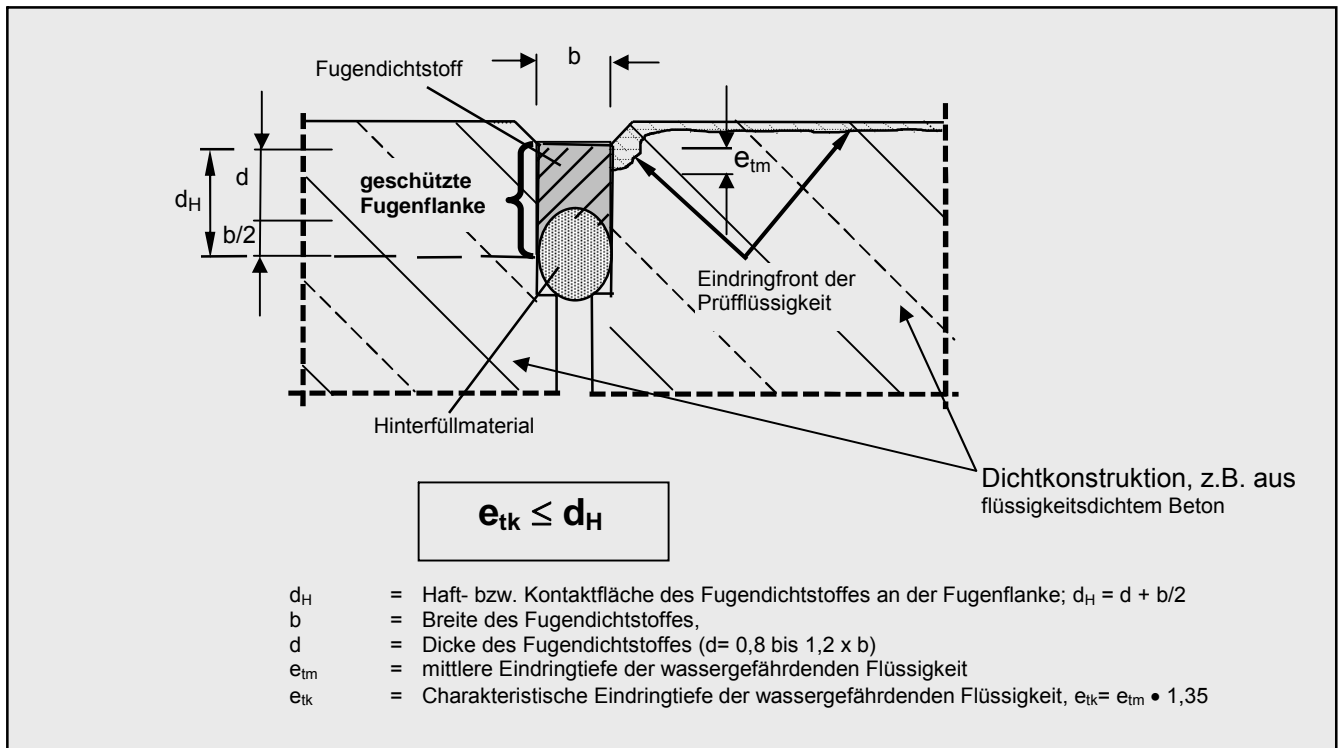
Dichtkonstruktionen mit integriertem Fugenabdichtungssystem nach [5. 9, 5.11 und 5.30]
